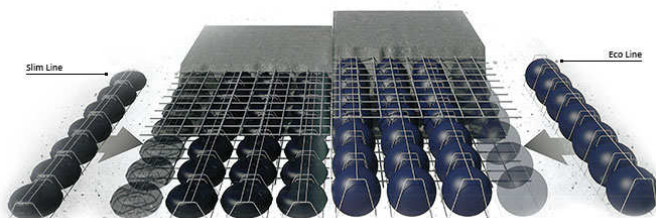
U-Boot Beton – tvarovky (zdroj [9])
